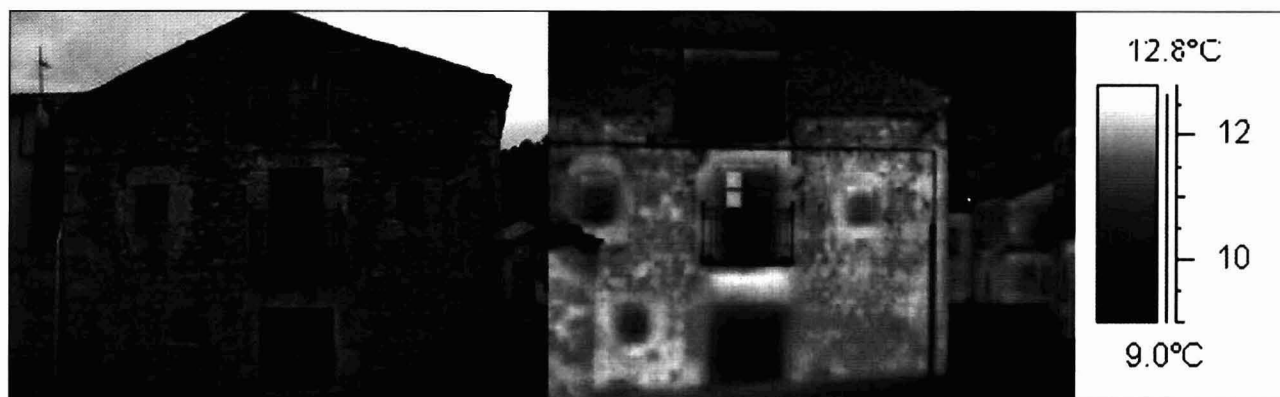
Fachada de una vivienda rural. Las dos primeras plantas están realizadas en mampostería de piedra y la planta de cubierta en adobe. La termografía muestra el diferente comportamiento de estos materiales. Tomada al anochecer.
